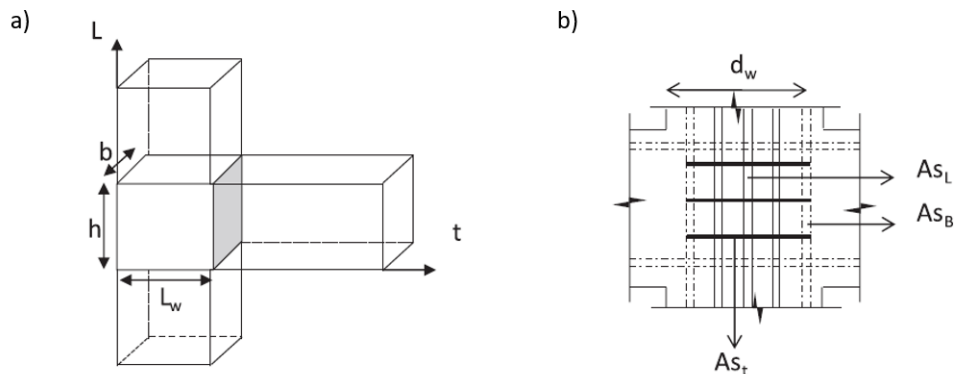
a) Geometría típica de una unión viga-columna exterior. b) Representación de la armadura de una unión [14]
